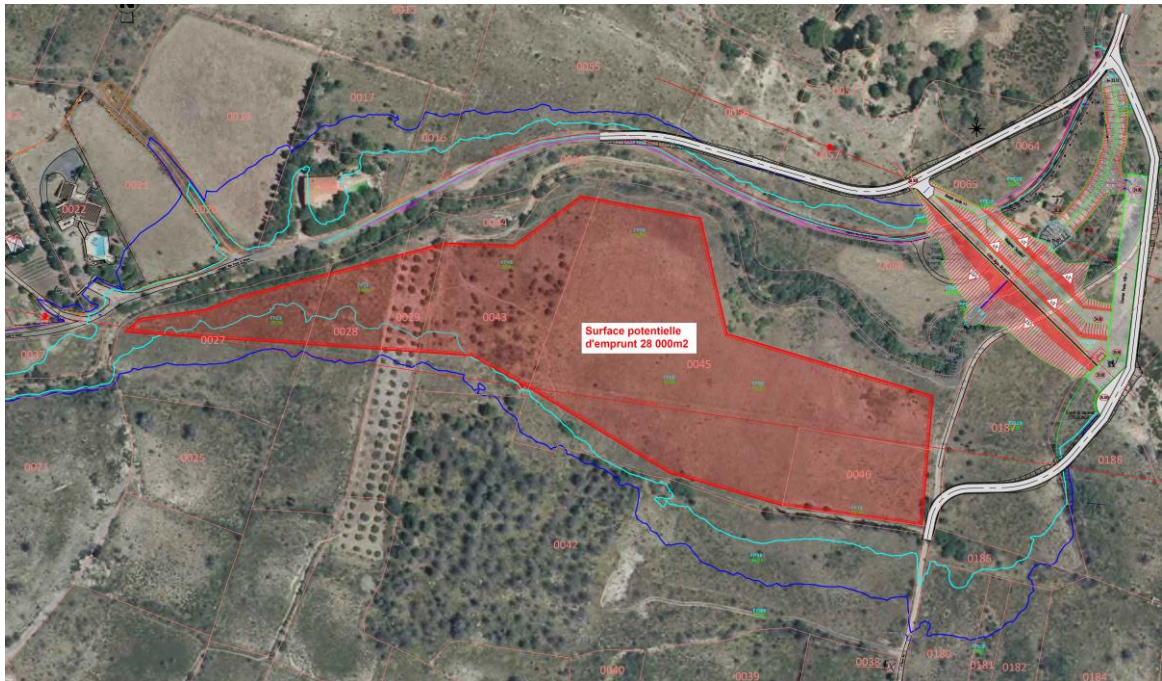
Zones d'emprunt potentielles sur le site de la Plaine
